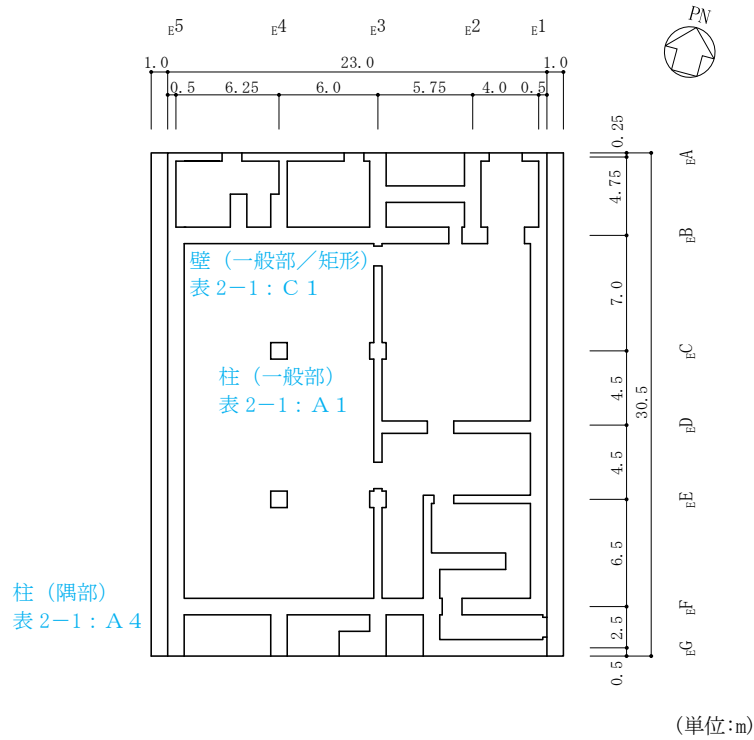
緊急時対策所の概略平面図 (EL 50.25m)
